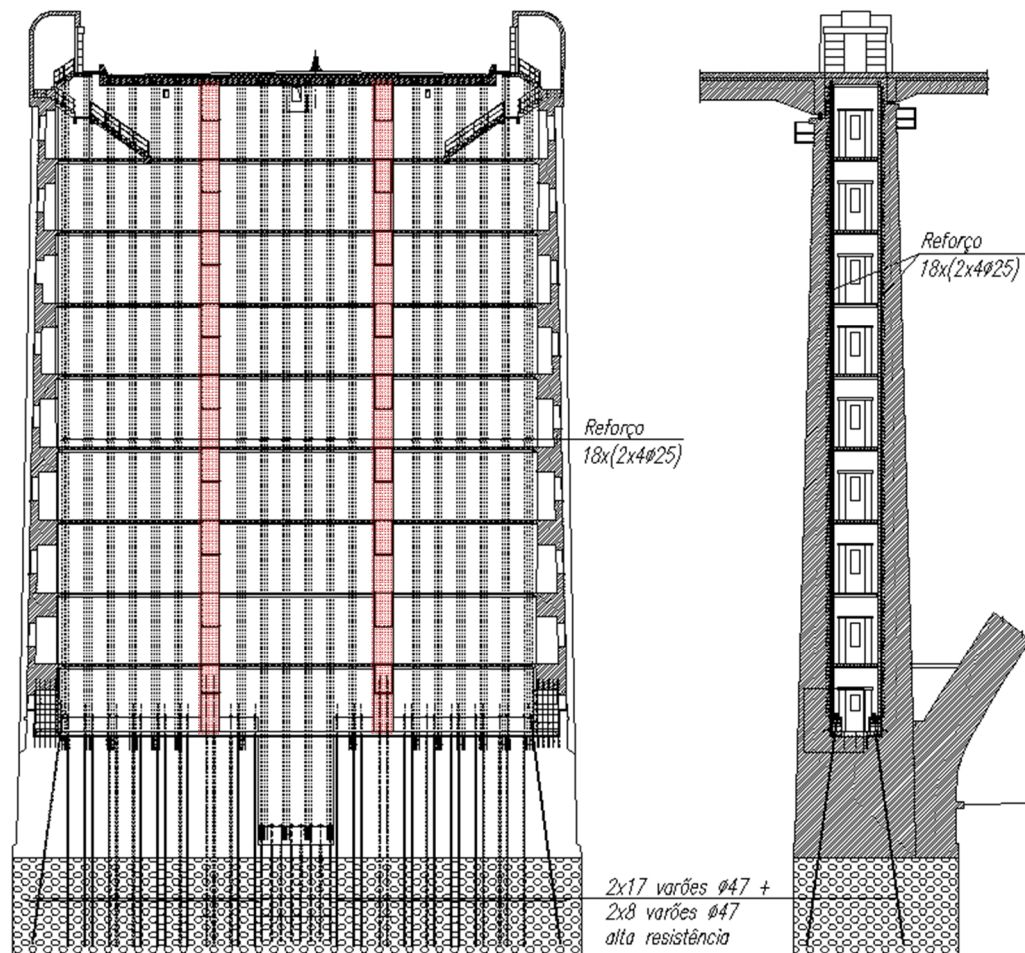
Corte longitudinal e transversal das pilastras ilustrando a solução de reforço.
